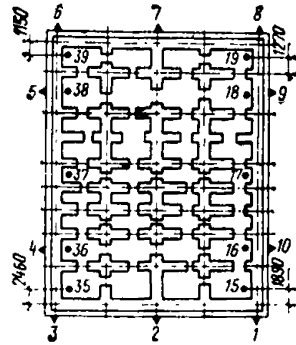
Схема расположения марок на верхней плите коробчатого фундамента
